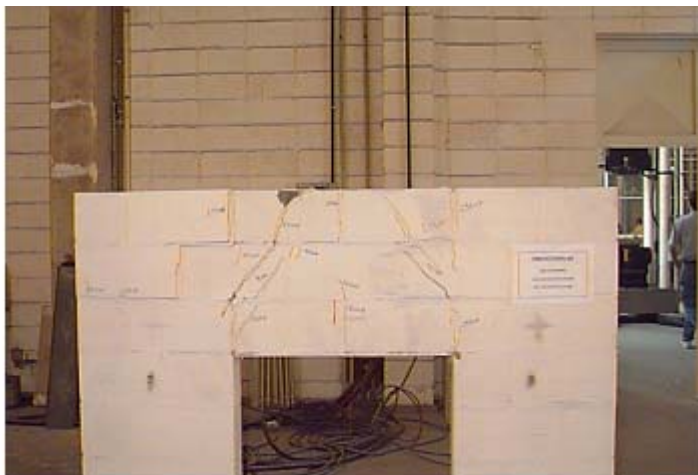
Configuração de fissuras da parede sem revestimento.
